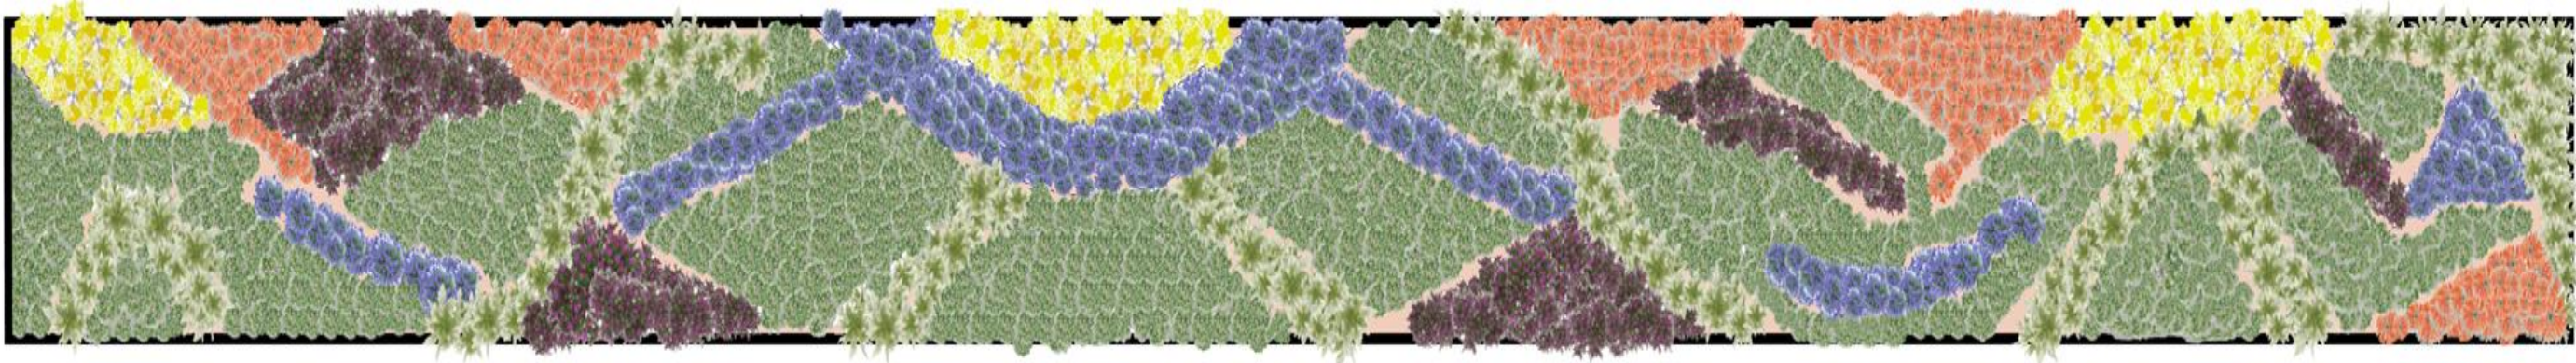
Plano de plantación y siembra para el Sector "B". Fuente: creación propia.
